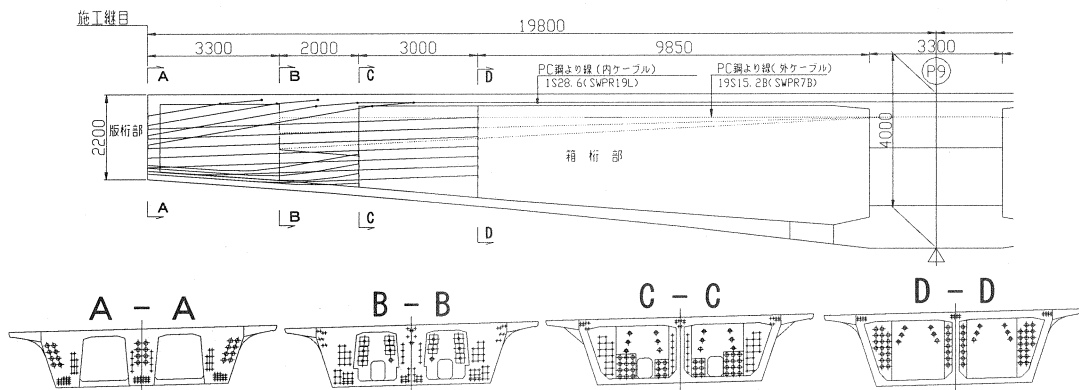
主ケーブル配置図 (箱桁~版桁たすき掛け部)
